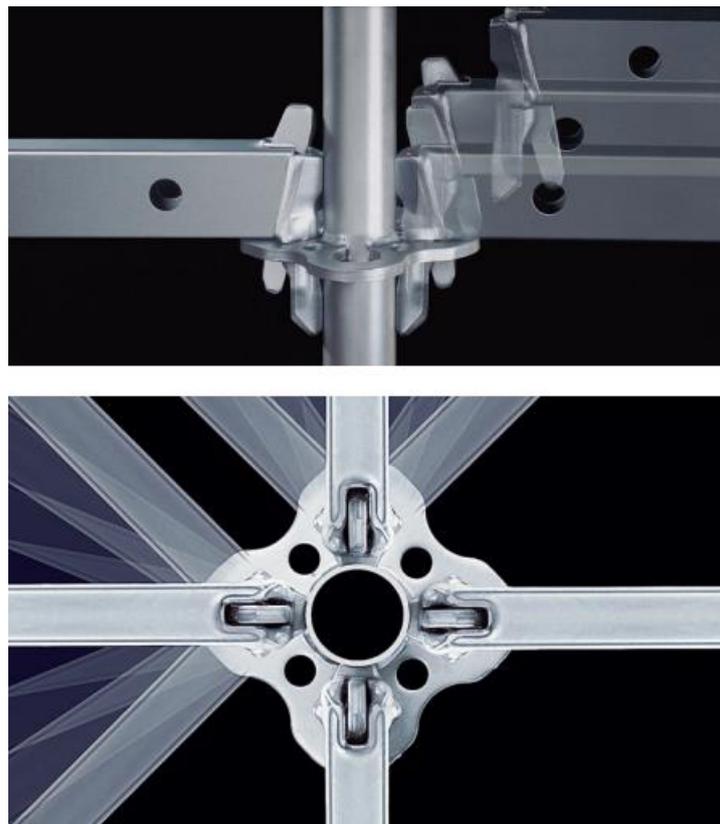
Arriba detalle del nuevo cierre por gravedad, abajo detalle de nudo en planta con roseta en sistema Peri Up Rosset.
